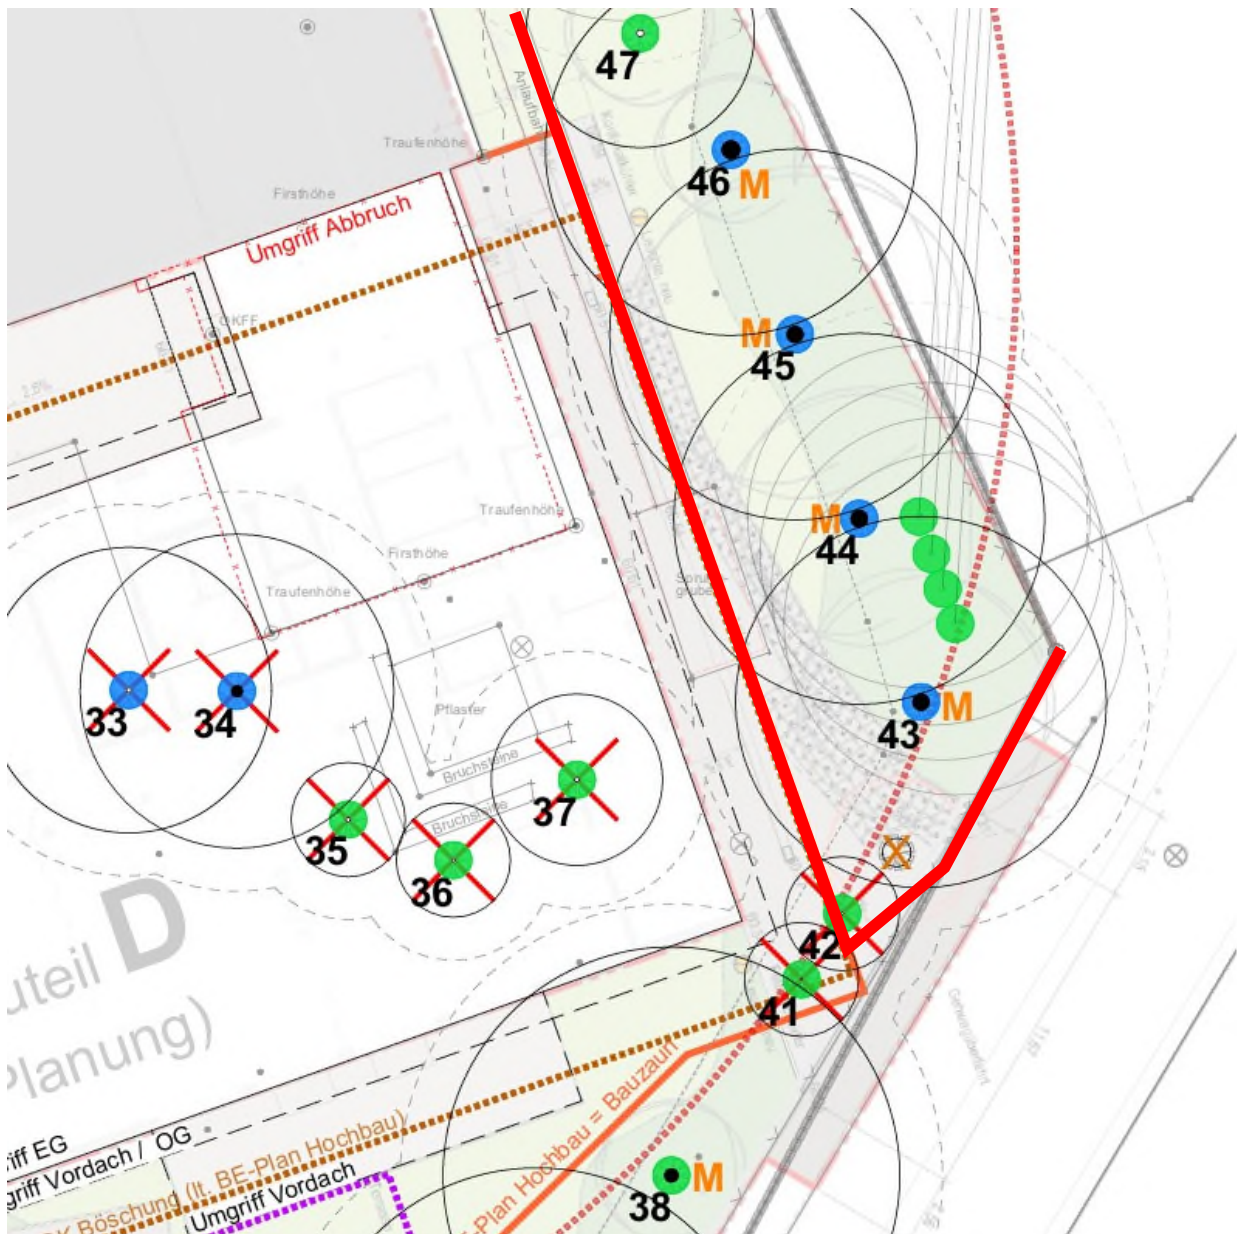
Ausschnitt des Lageplanes mit den vier Mehlbeeren. Rot skizziert ist der unverrückbare Holzzaun
